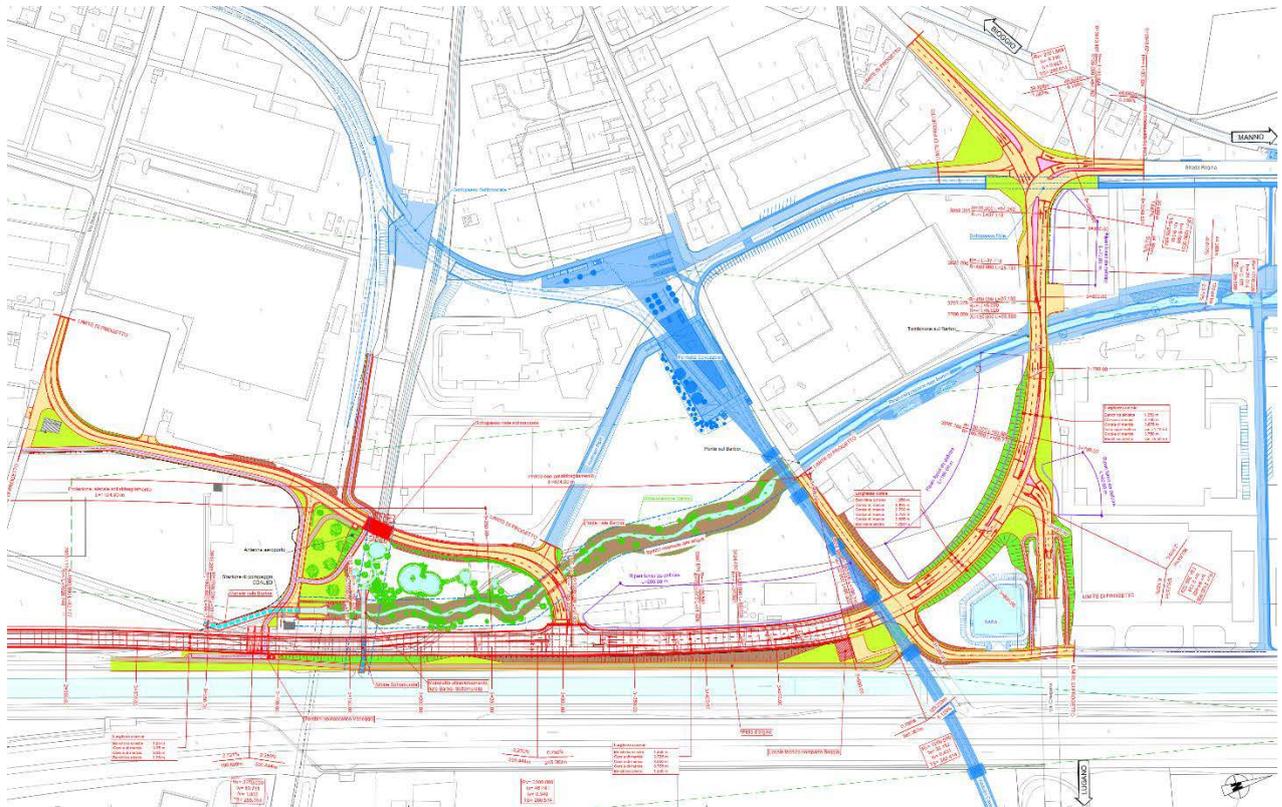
Estratto planimetrico comparto Bioggio. In blu è rappresentato il progetto parallelo della RTTL
